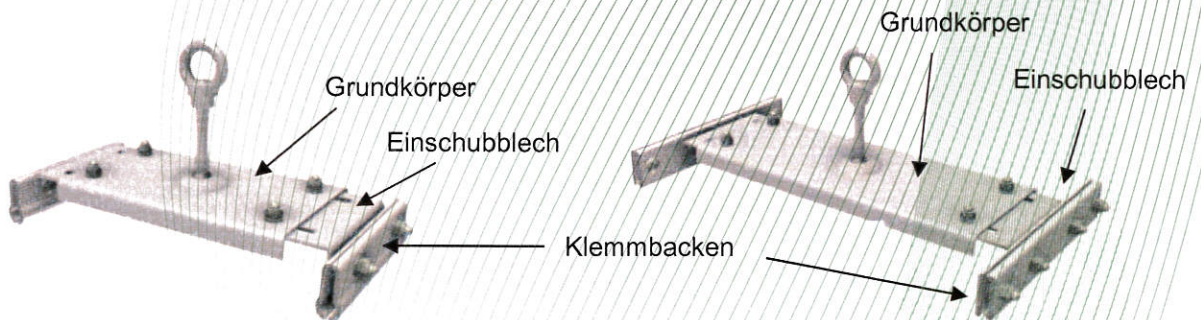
Anschlageinrichtung, Typ: LUX-top® FALZ-PLUS für Stehfalzprofile
